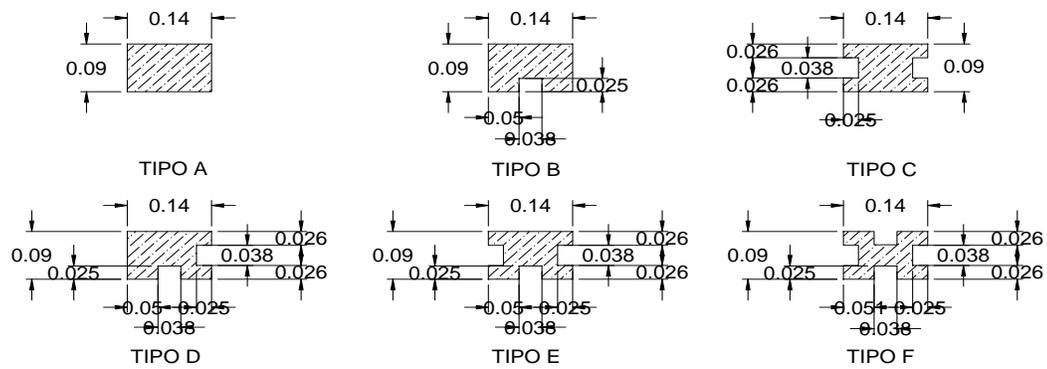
Tipos de columnas, San Rafael, Alajuela, 2012.
